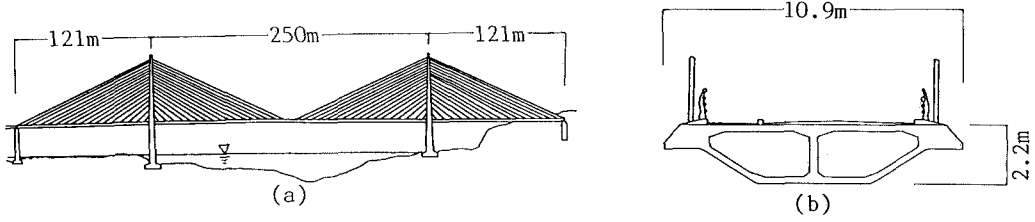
呼子大橋の側面図(a)と主桁の断面図(b)
